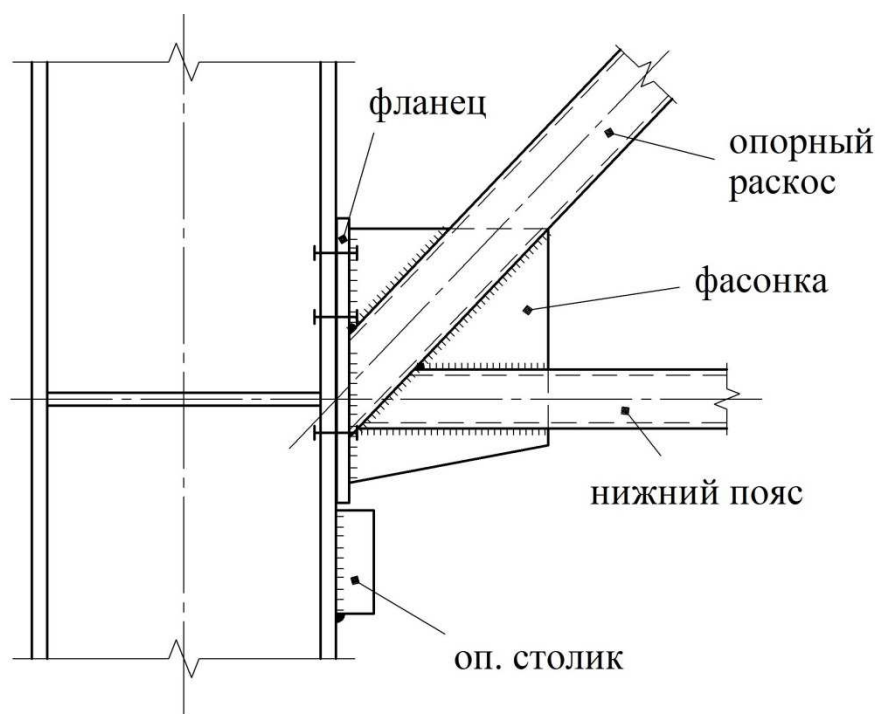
Вариант опорного узла стропильной фермы-ригеля рамы из замкнутых гнутых профилей
